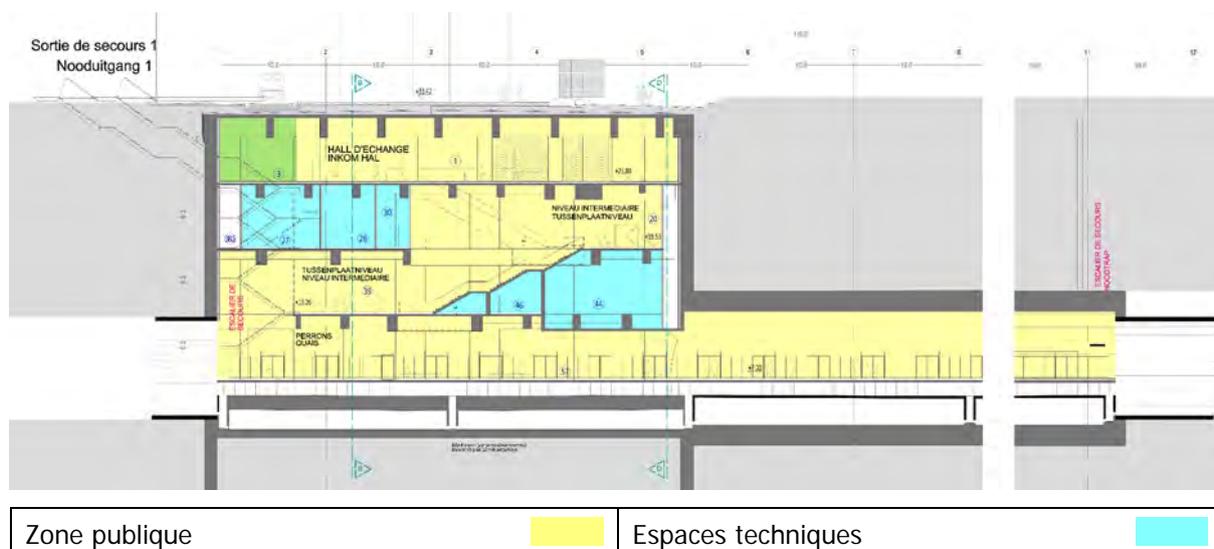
Station Colignon, coupe longitudinale (BMN, 2018)
